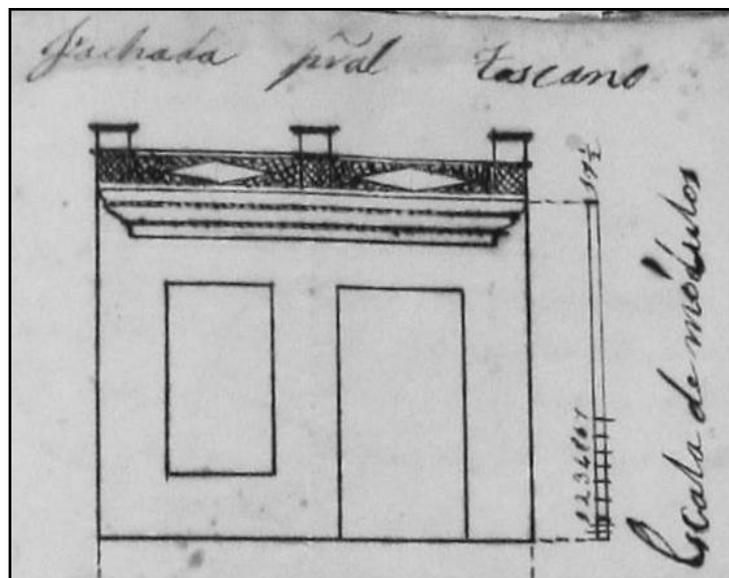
Proyecto de vivienda en la calle Santa Rosa. Octubre de 1859.
